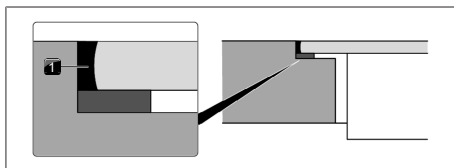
Silikoneforseglingsmasse ved planimet montering
